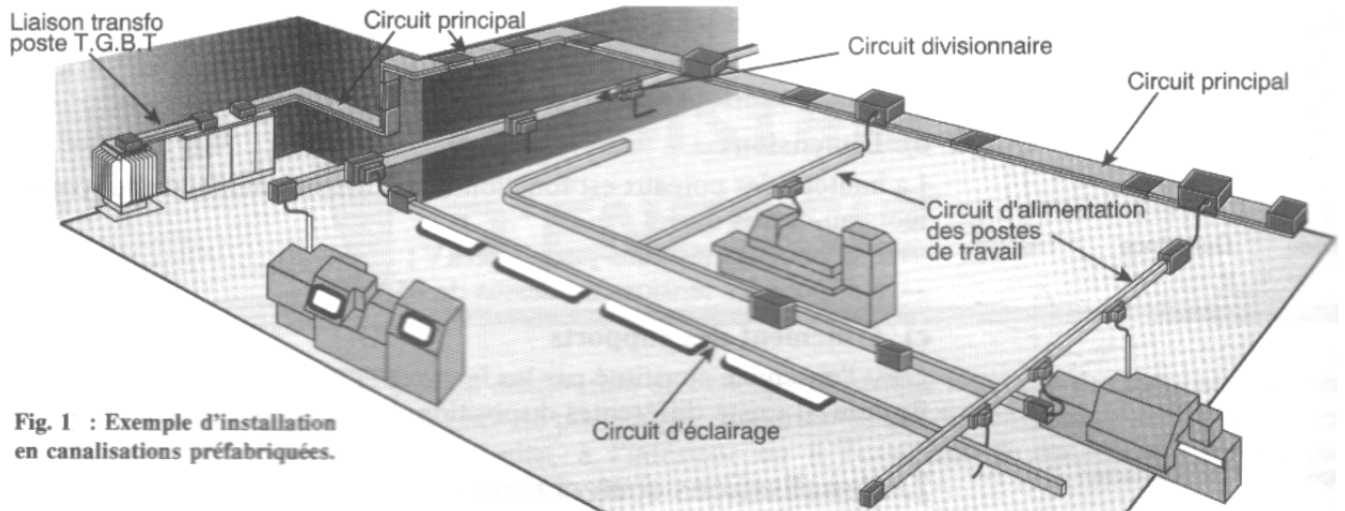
Exemple d'installation en canalisations préfabriquées.
